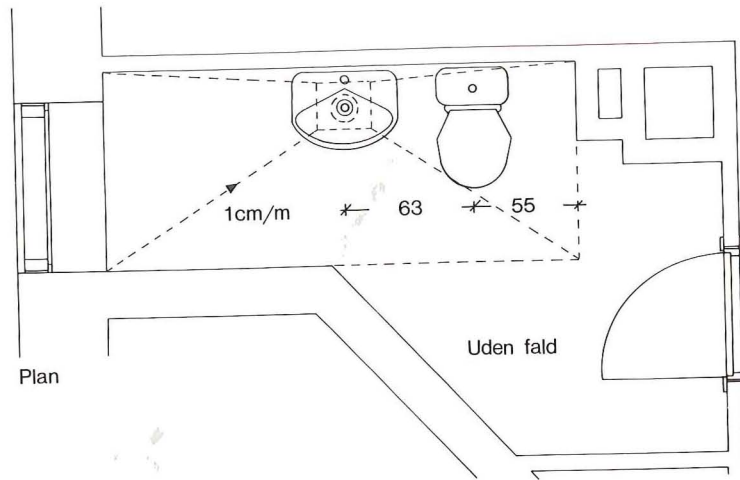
Plan og opstalt af toilet, type B. Tegningen viser, hvor VVS-installationer skal placeres og hvordan de skal udføres.
